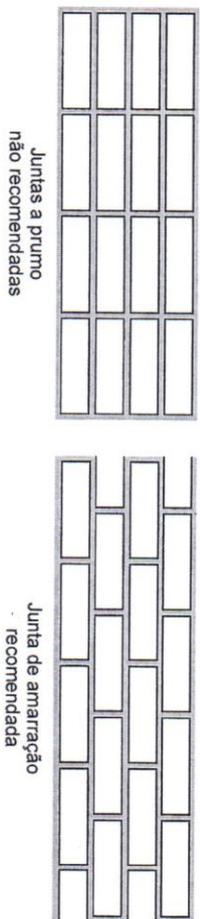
Tipos de amarração entre os blocos de alvenaria.
